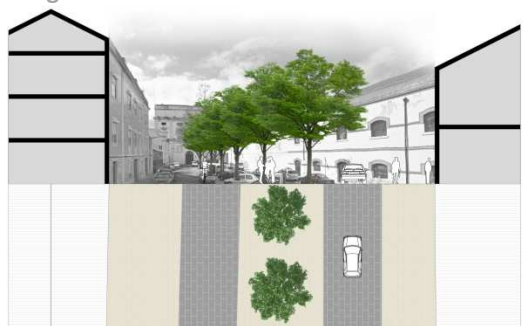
| Perfil de via sugerido para a Alameda do Beato.
